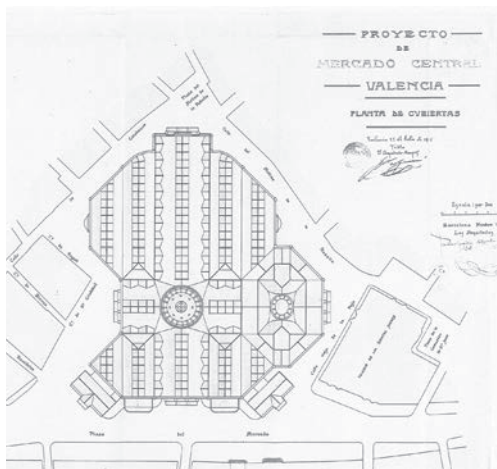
Planta de cubiertas. Archivo servicio de arquitectura del Mercado Central de Valencia
